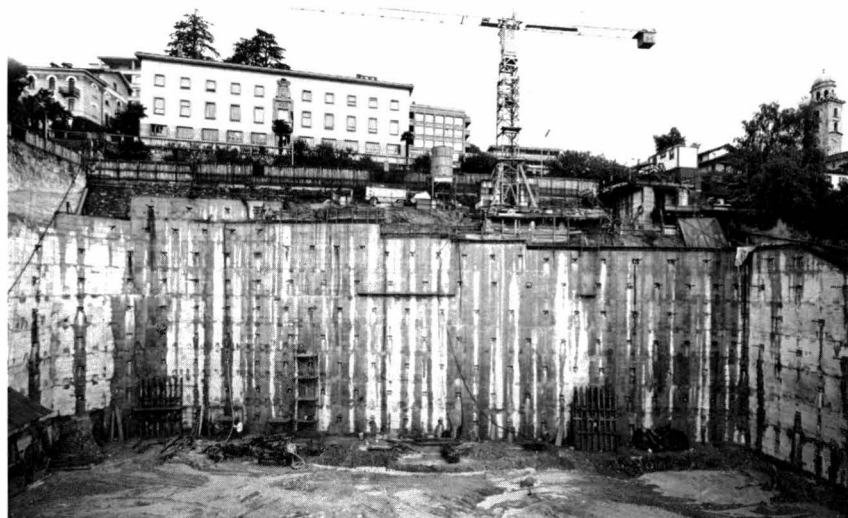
Ansicht der gesamten Baugrube mit Elementwand – Vue de la fouille avec paroi ancrée – Vista d'assieme con la parete ancorata
